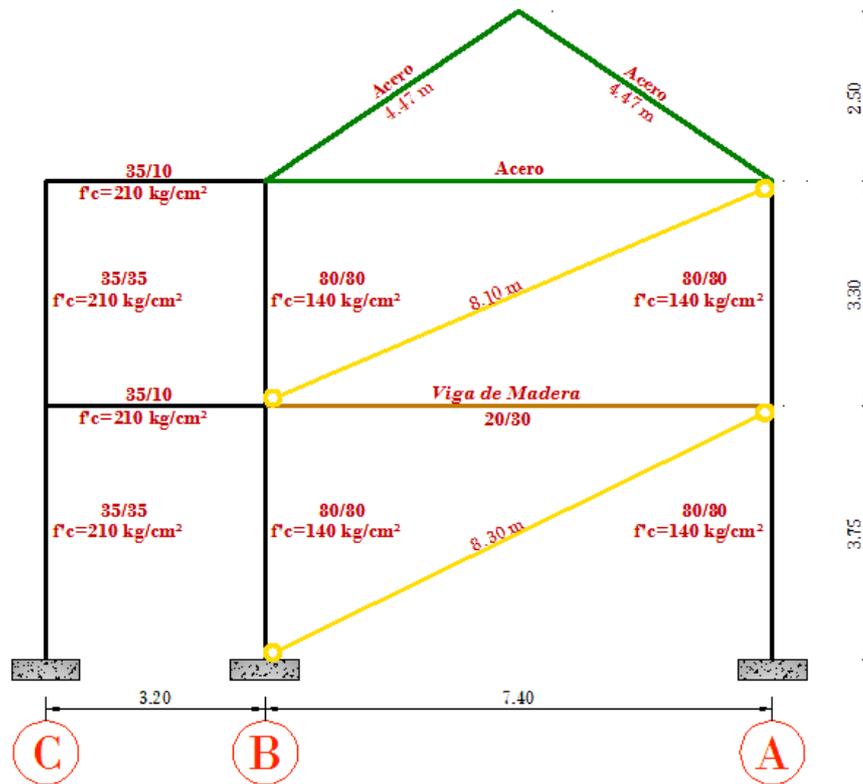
Características de los elementos estructurales y dimensiones en los pórticos. (Pérez, 2013).
